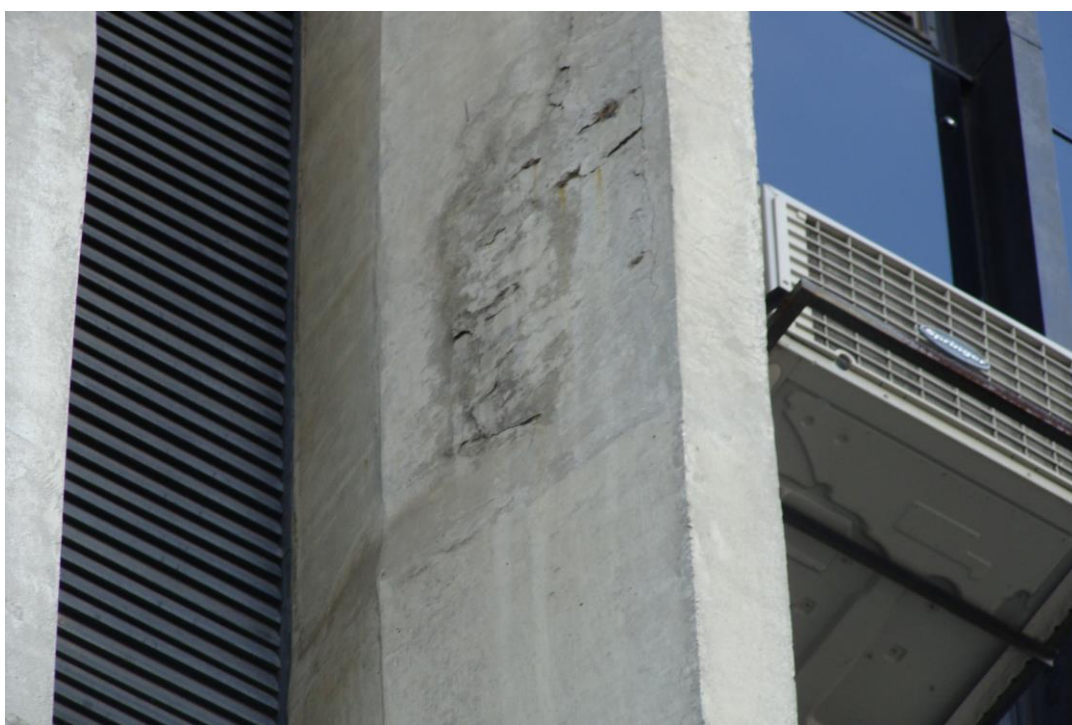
Armadura exposta pilar P13 (3º pavimento) (19/11/2013)
